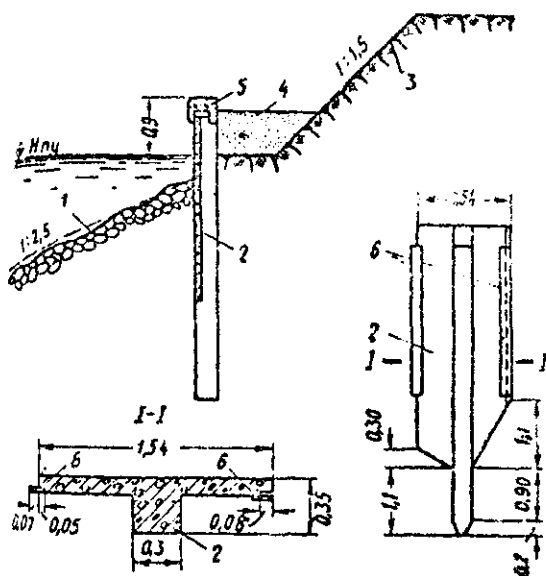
Крепление откосов вертикальными стенками из железобетонного шпунта.
